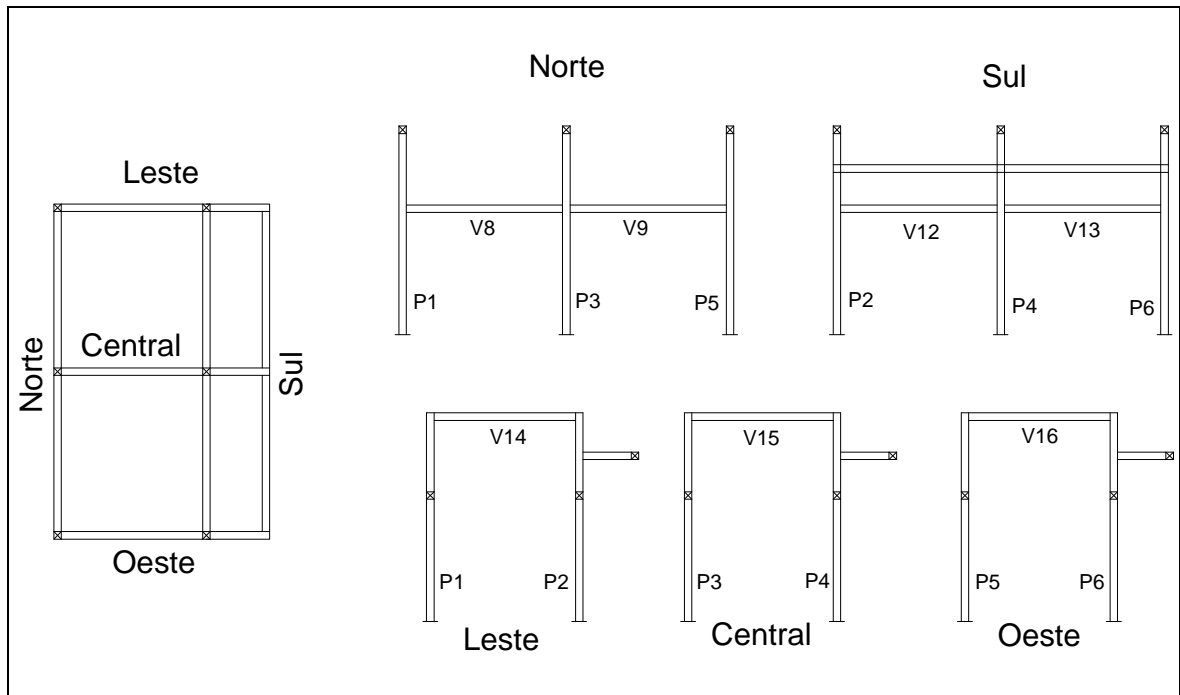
Planta e vistas do pórtico espacial estudado.
